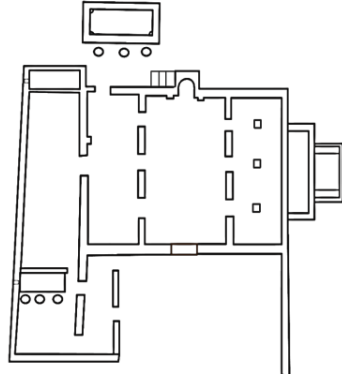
مسقط أفقي لمسجد متواجا الجامع (عمل الباحث)
